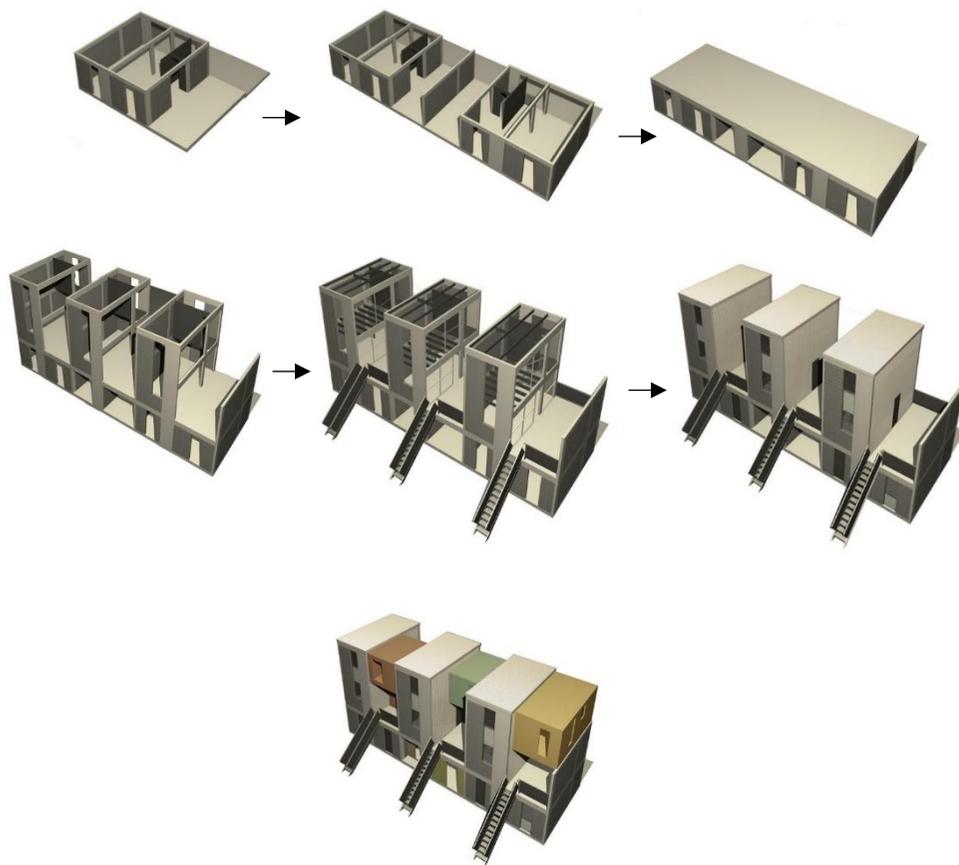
Zoneamento da projeção segundo pavimento (Fonte: Archidaily 2012 – modificada pelo autor)
